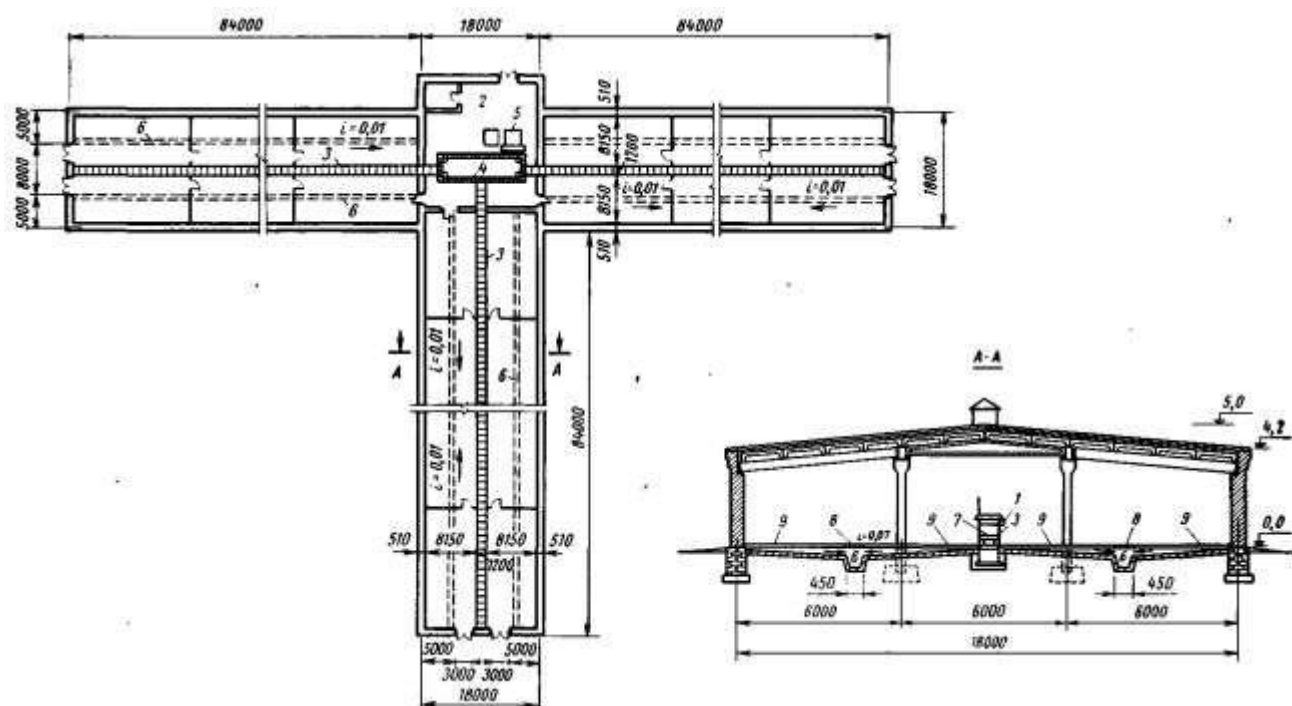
Здание для беспривязного содержания КРС на 2800 голов: 1 – труба для смыва навоза $\varnothing 100$ мм; 2 – кормоприемочная; 3 – раздаточный скребковый транспортер; 4 – кольцевой раздаточный транспортер; 5 – бункер - дозатор; 6 – навозный канал; 7 – эстакада для обслуживания; 8 – чугунная решетка; 9 – щелевой деревянный пол
